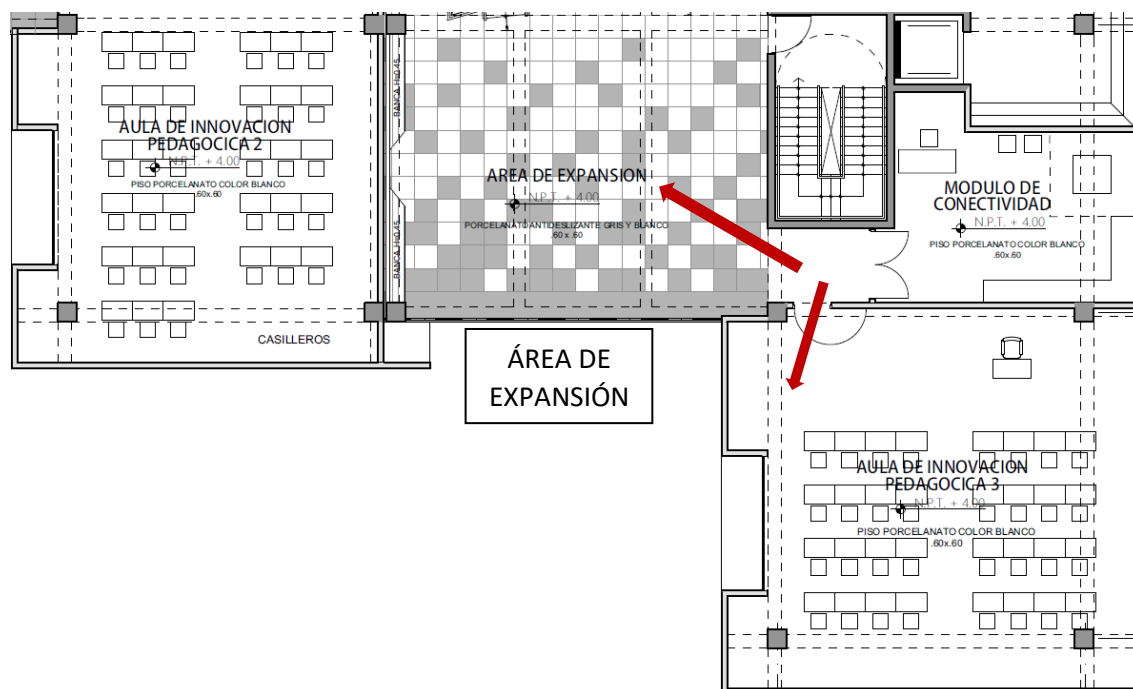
Planta de 2 AIP en relación al módulo de conectividad
